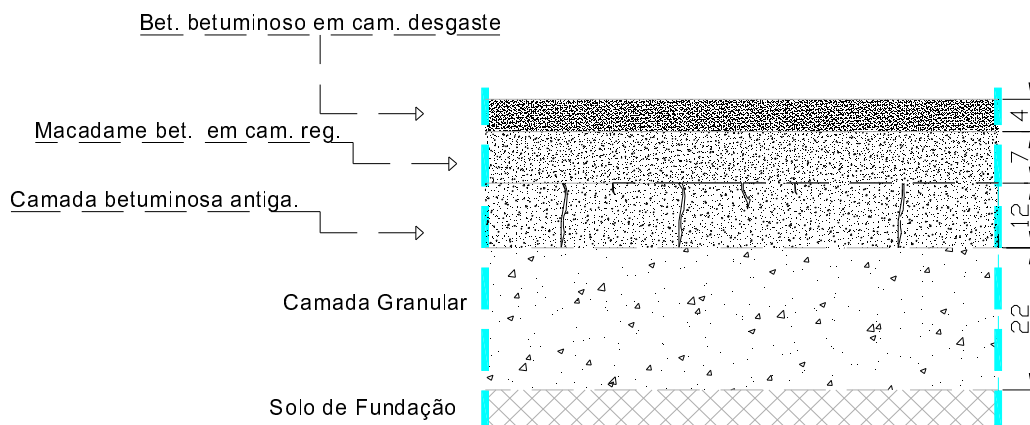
Estrutura do pavimento da Rua Associação Artística Vimaranesense para a alternativa de reforço
